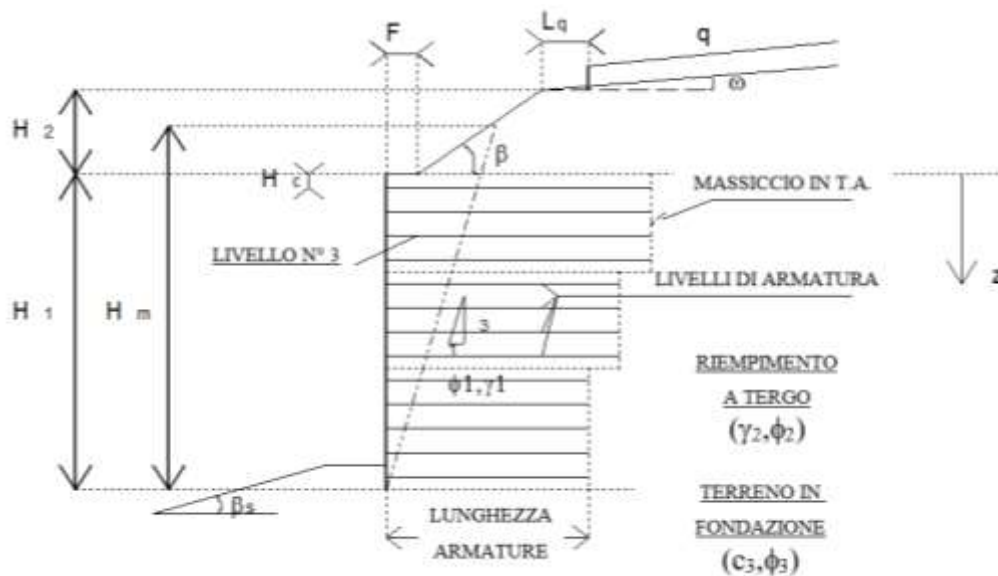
Sezione trasversale di un muro in terra armata (es. sezione trapezoidale)
